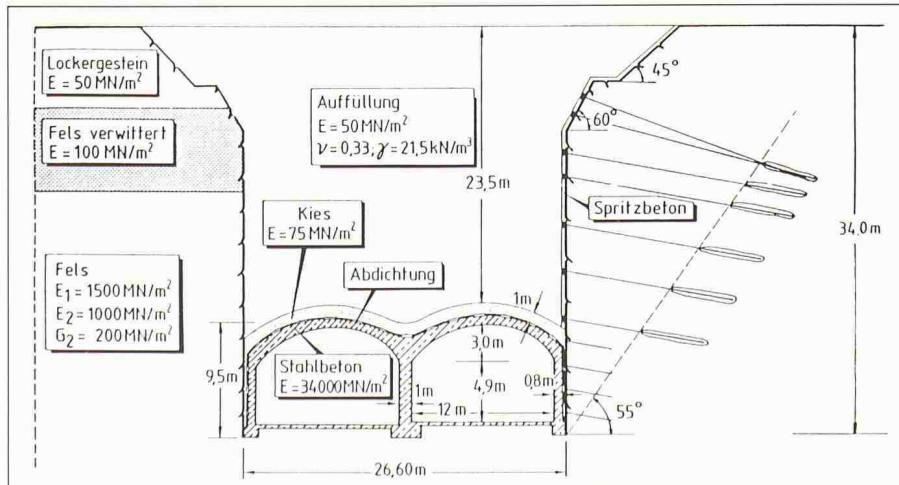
Statisches System des Ausführungsentwurfs mit Kennwerten für den Strassentunnel Grosser Busch (Pierau)
